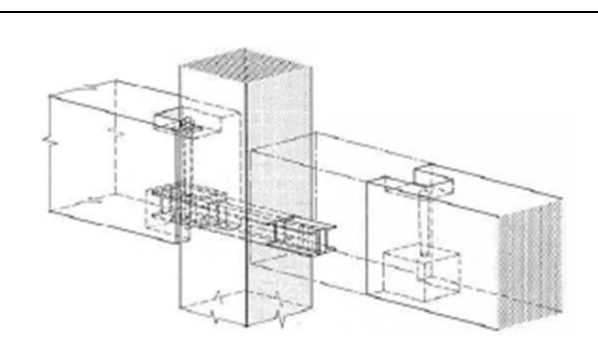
Ligação por consola curta metálica (Stupré, 1981)
